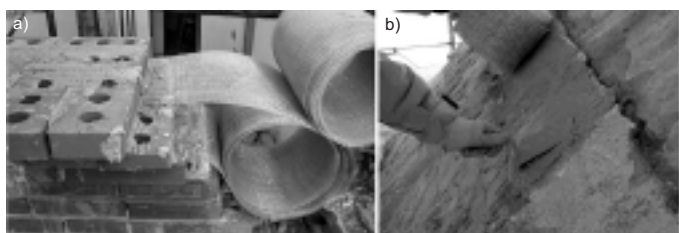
Przykład zastosowania kompozytów SRP do wzmacniania konstrukcji betonowych
